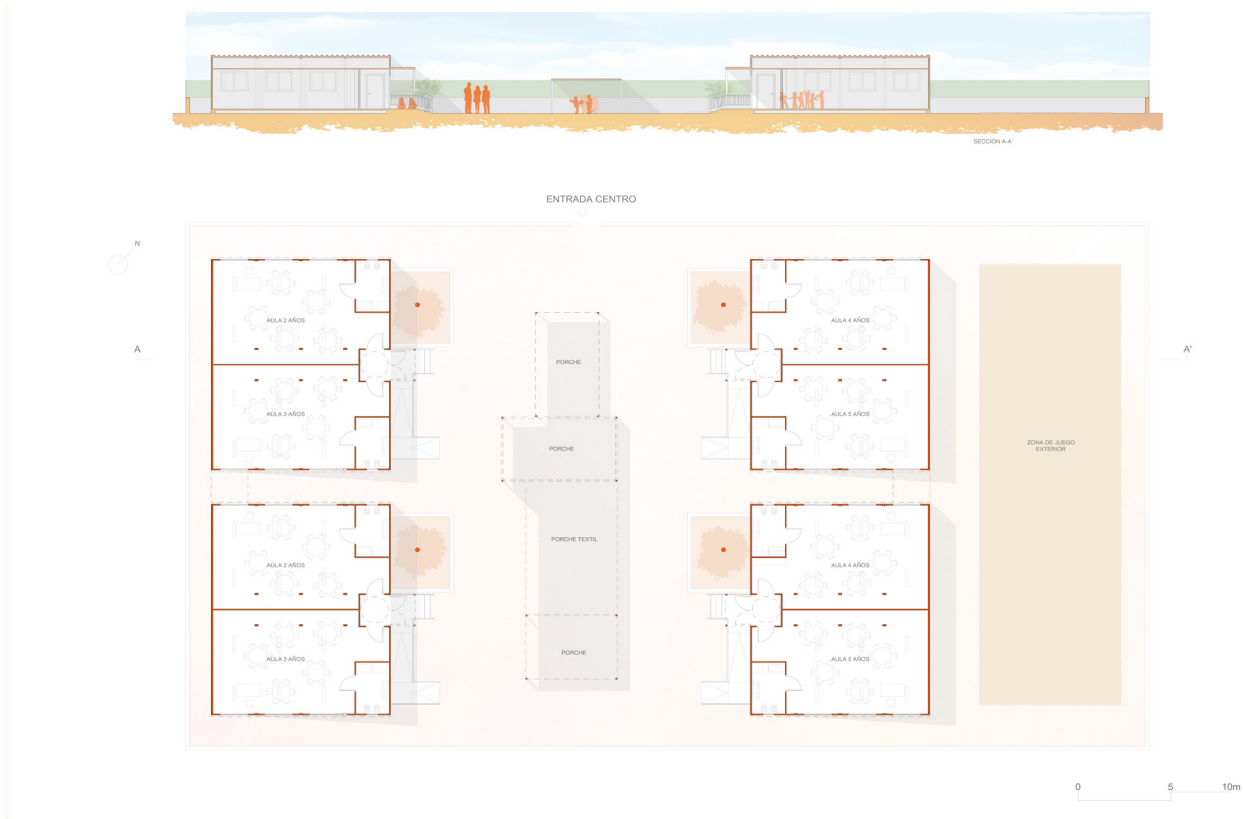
Planimetría del colegio de educación infantil temporal "Caracolas" en Utrera (Sevilla). Fuente: Elaboración propia.
